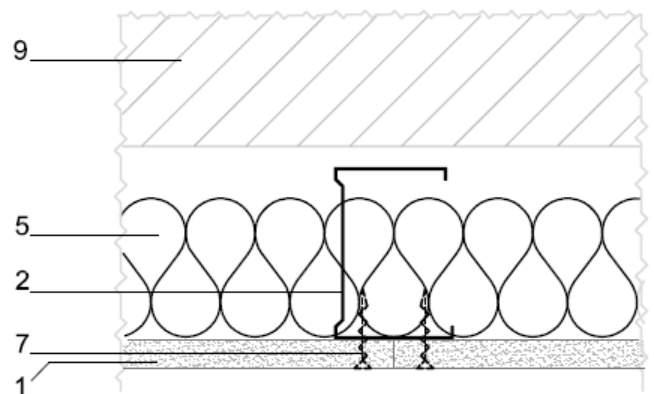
Sección horizontal de un tabique con subestructura doble y panelado simple con placa intermedia (sin arriostrar).
